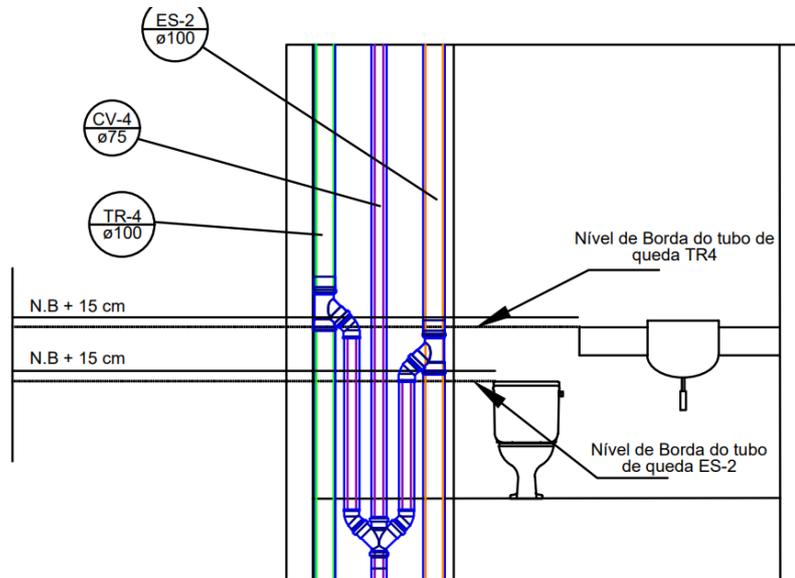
Planta baixa do sanitário dos banheiros dos apartamentos do 2º andar após a implantação do sistema de reúso.
